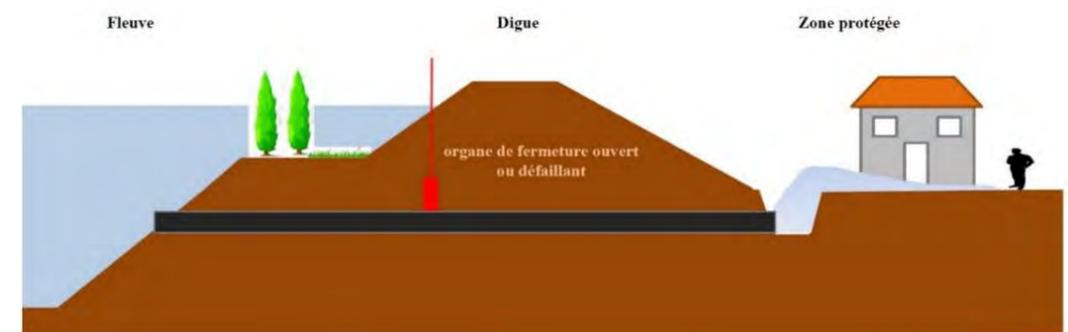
Défaillance d'un ouvrage hydraulique traversant
